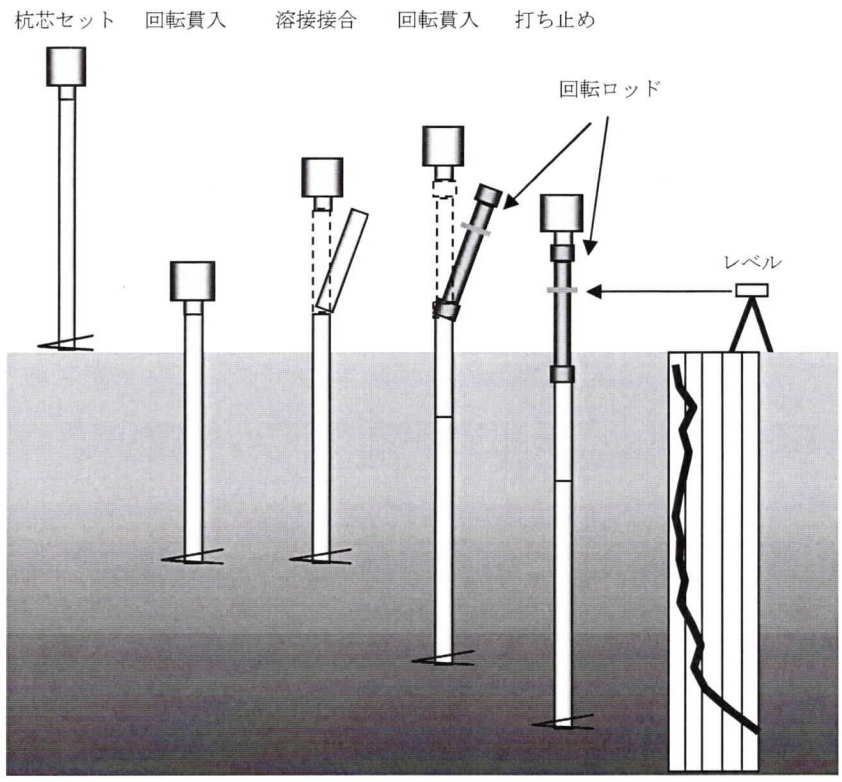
本ぐい施工フロー及び施工手順 地盤柱状図
